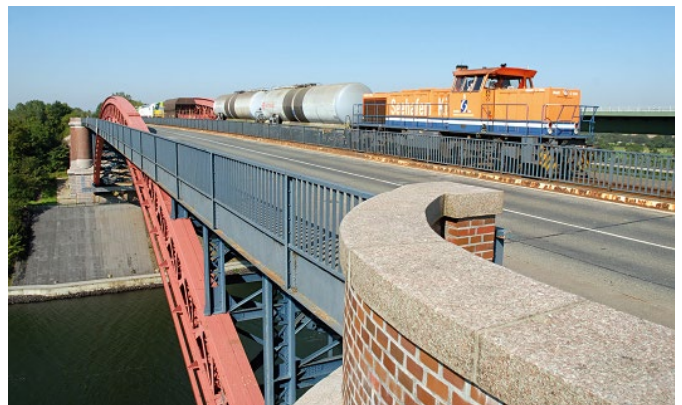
Fahrbahn Hochbrücke Levensau heute (Foto: WSV/Behling)
